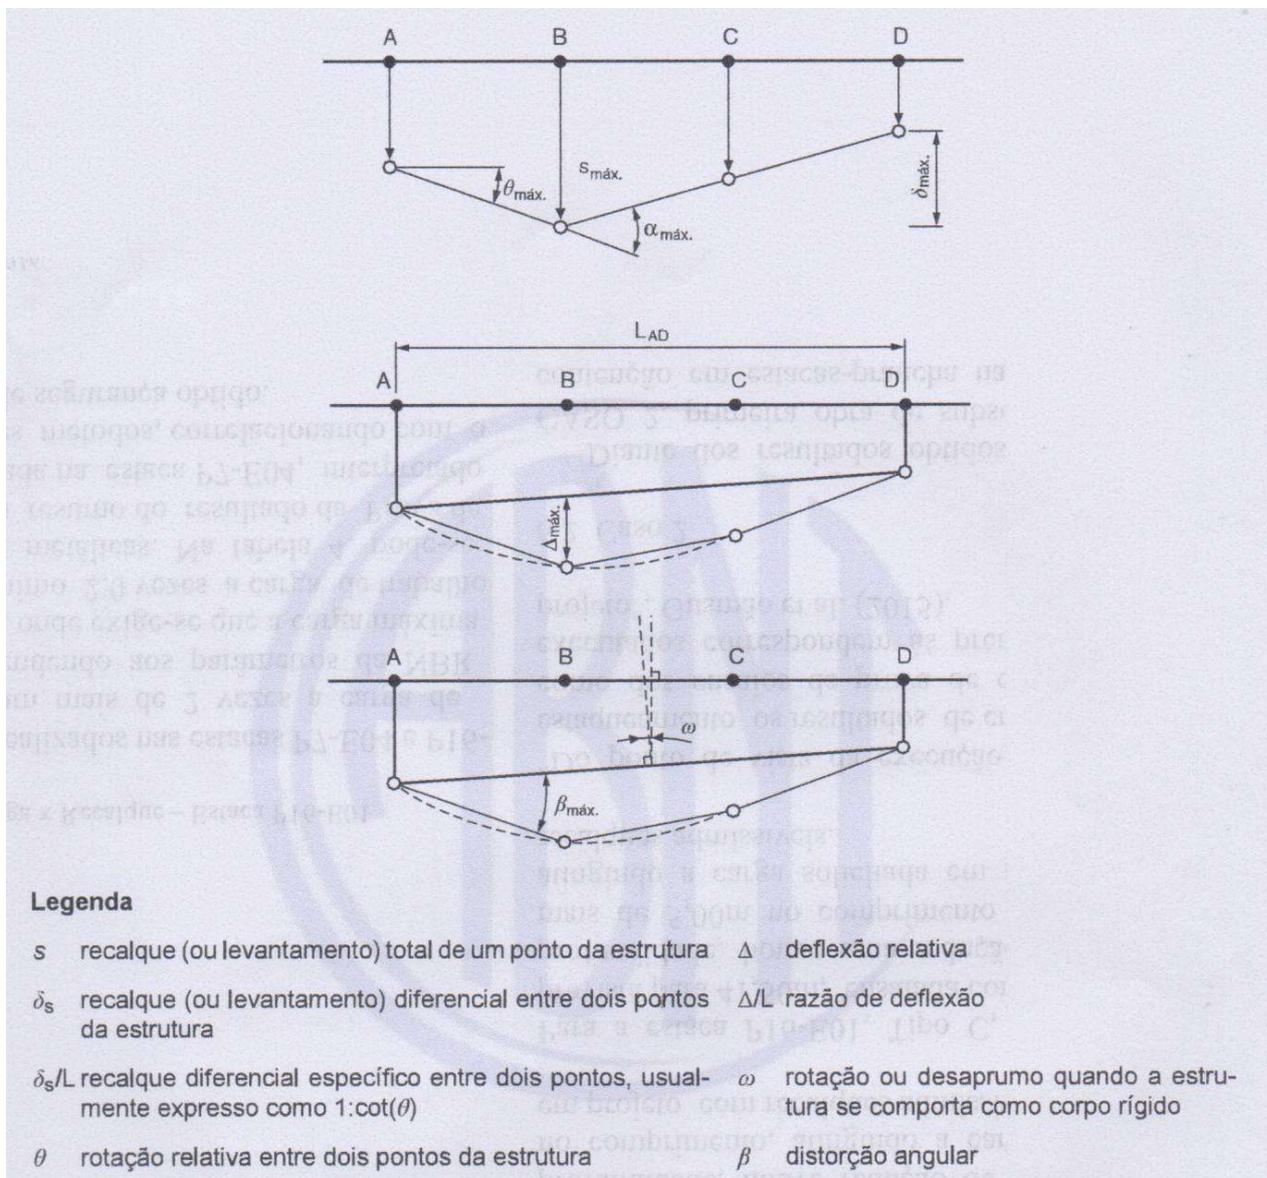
Movimentos verticais da fundação e medidas angulares decorrentes
